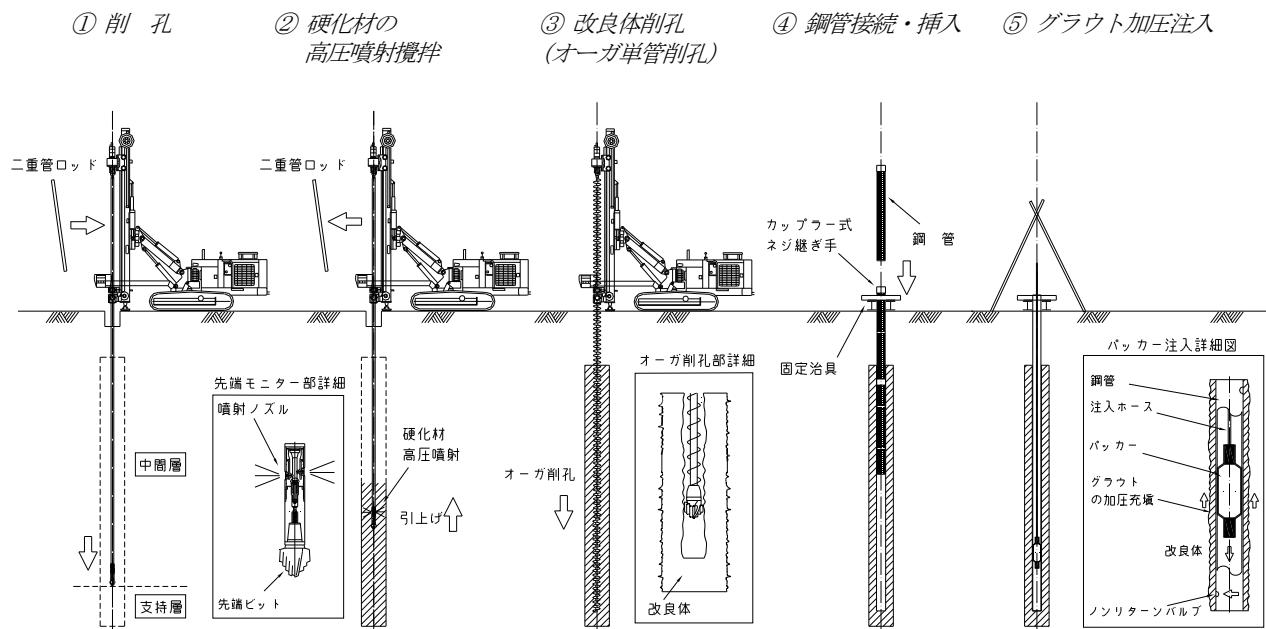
STマイクロパイル タイプIIの標準的な施工手順
